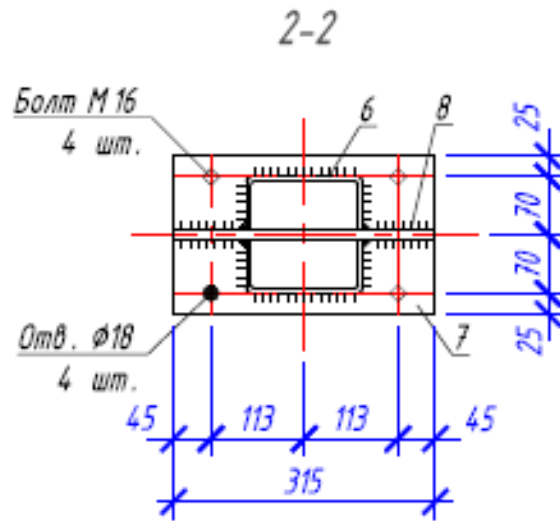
Запропоноване конструктивне вирішення вузла опирання стійки (база стійки) на стовпчатий монолітний залізобетонний фундамент (вид зверху).
